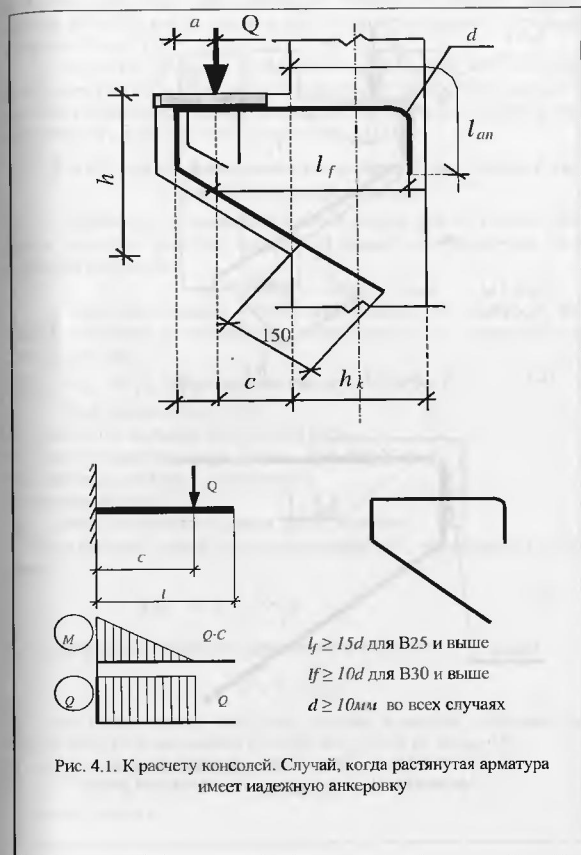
К расчету консолей. Случай, когда растянутая арматура имеет надежную анкеровку
